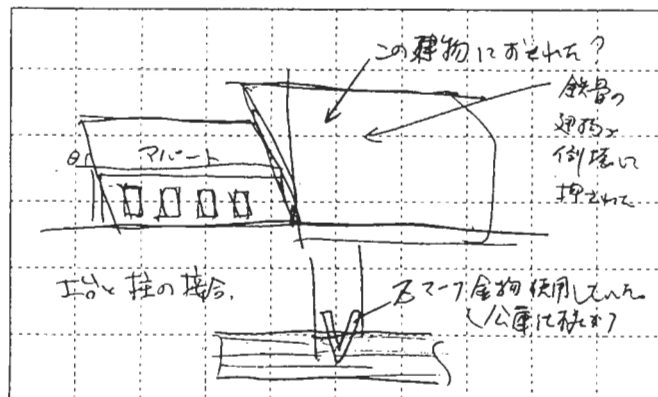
No.20-隣家に圧されて損壊した木造アパート (芦屋市三条南町)
